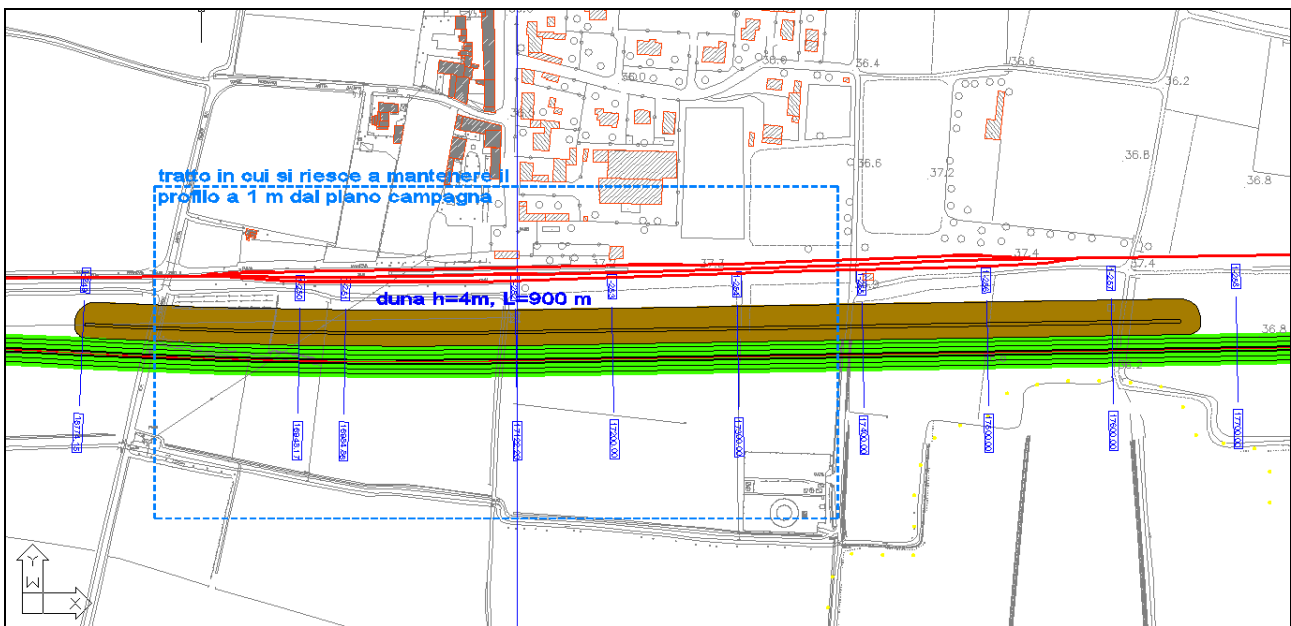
DUNA ANTIRUMORE – PIANTA
